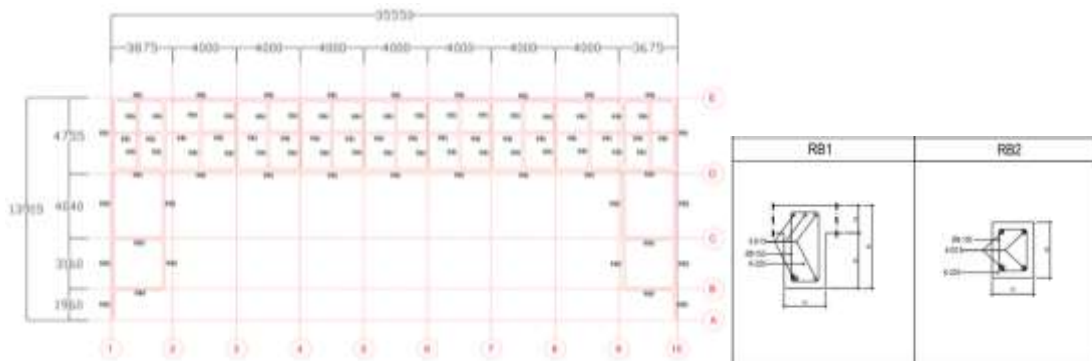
Denah dan Detail Elemen Sloof Bangunan Sekolah
